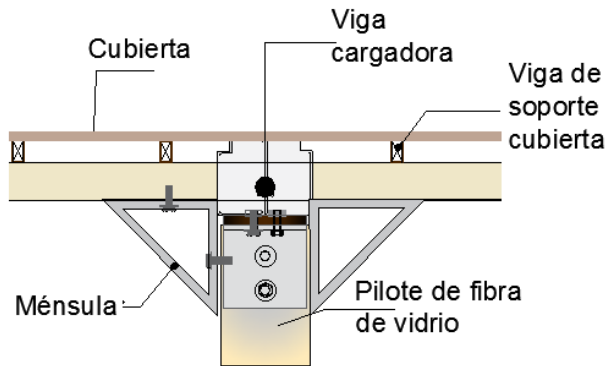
Detalle 2 (D-2) Soporte de cubierta
